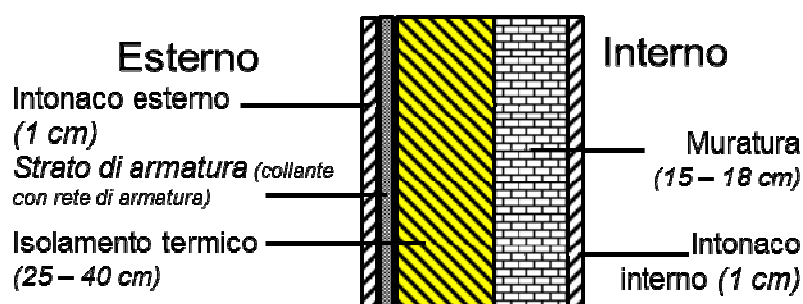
Parete di casa passiva di struttura massiccia con sistema termoisolante a cappotto
